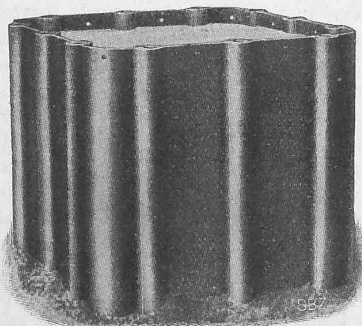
Spundwand mit Behrend'schen Profileisen.
